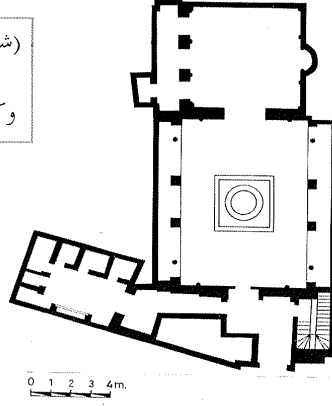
مسقط أفقي للدور الأرضي لمدرسة
